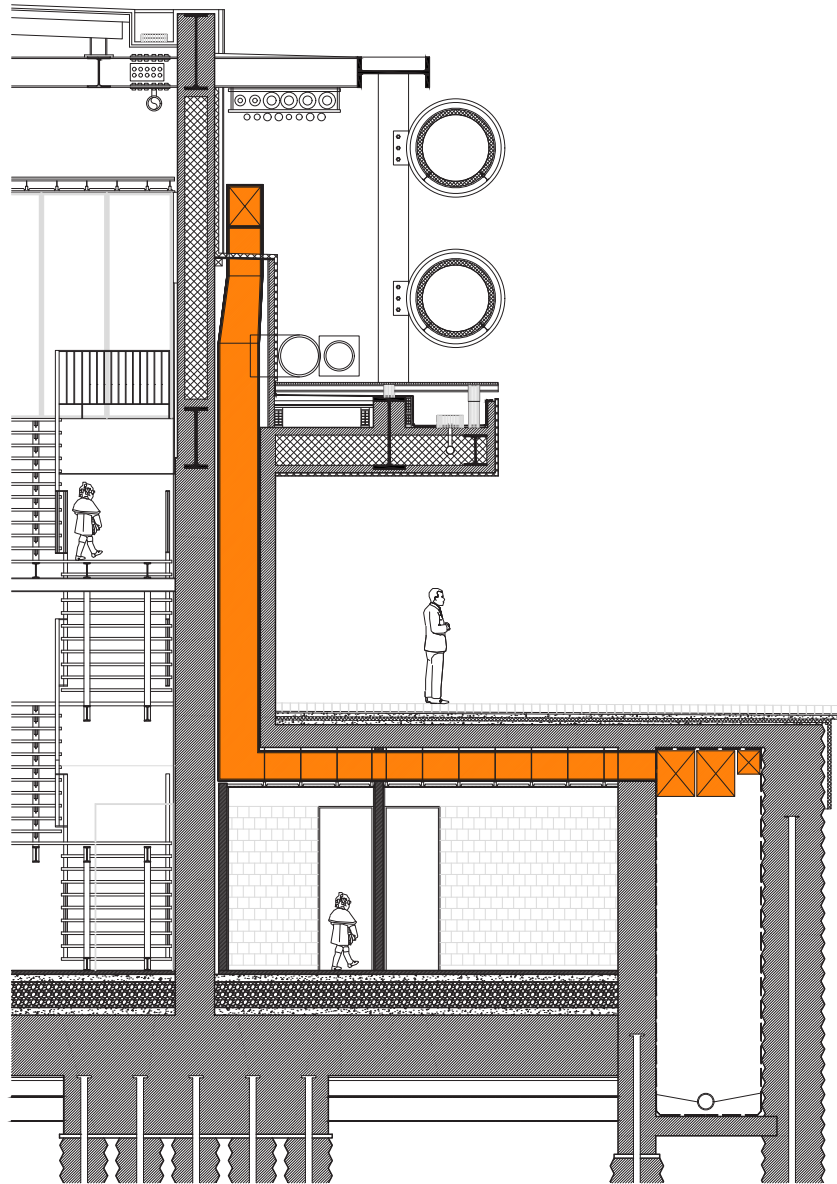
Sección construtiva por pilar. Escala 1/100.
